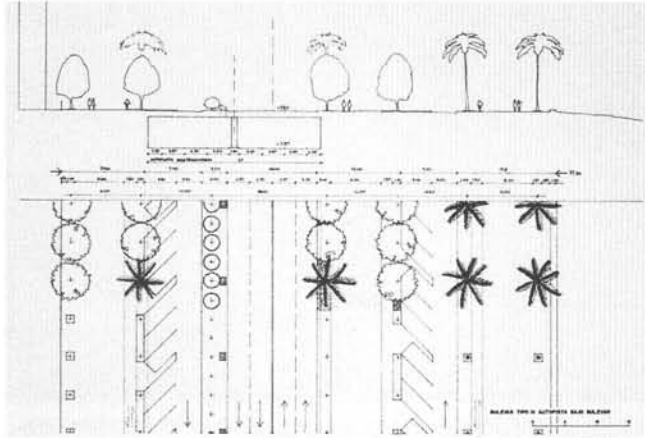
Sección y planta de bulvar y de tramo enterrado de nueva autovía.
